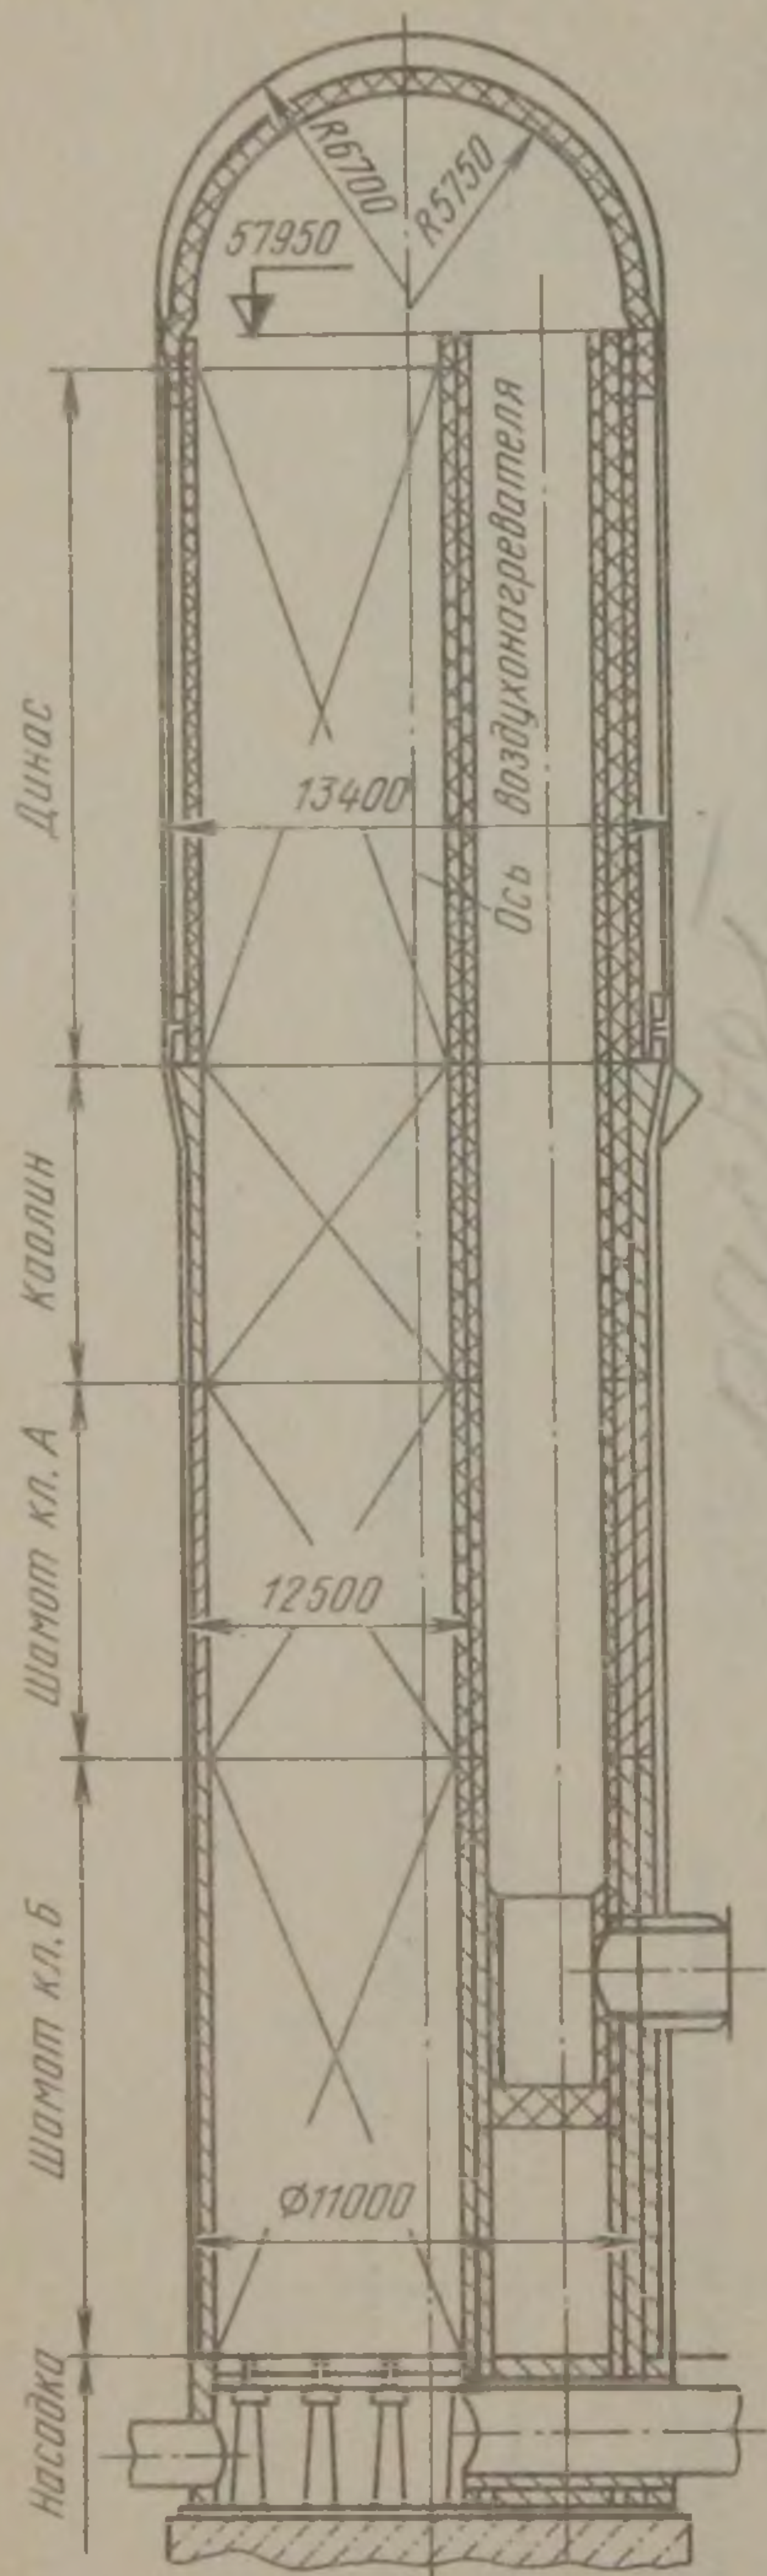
Доменный воздухонагреватель с четырехъярусной насадкой:
